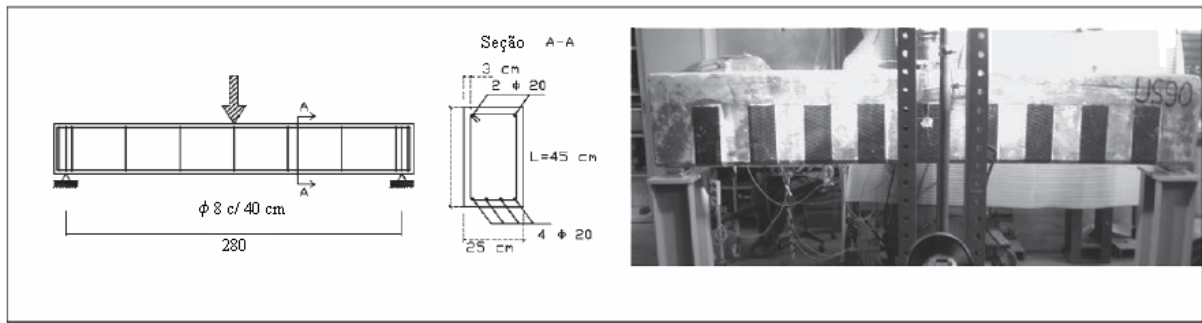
Detalhamento da viga referência e ilustração do ensaio experimental de Monti and Liotta (2006)
